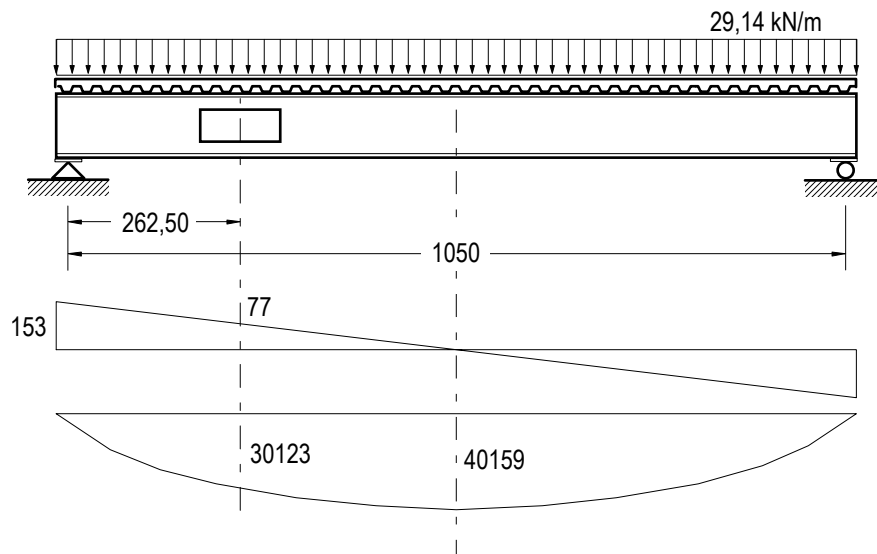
Viga do exemplo D1 após a cura do concreto
